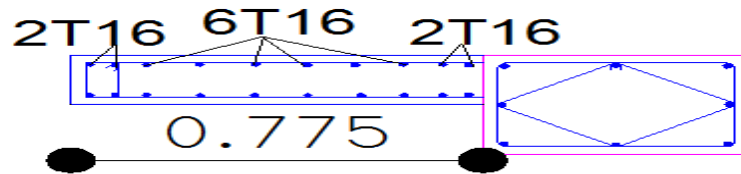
Shèma ferrailag de trummeau pour une face
